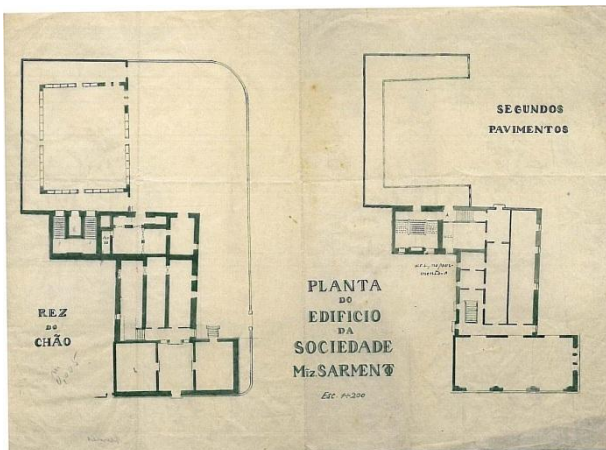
Planta da primeira fase de construção, 1903, Sociedade Martins Sarmento
